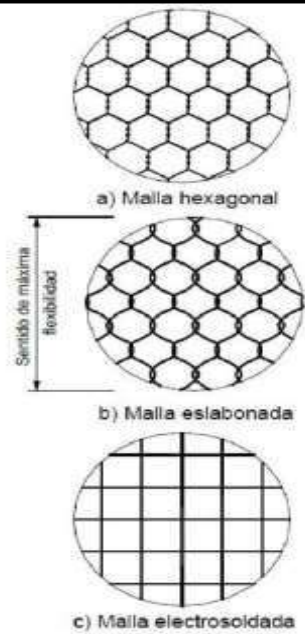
Tipos de mallas utilizadas en la construcción de gaviones. Fuente: (Suárez Díaz, 2001).
